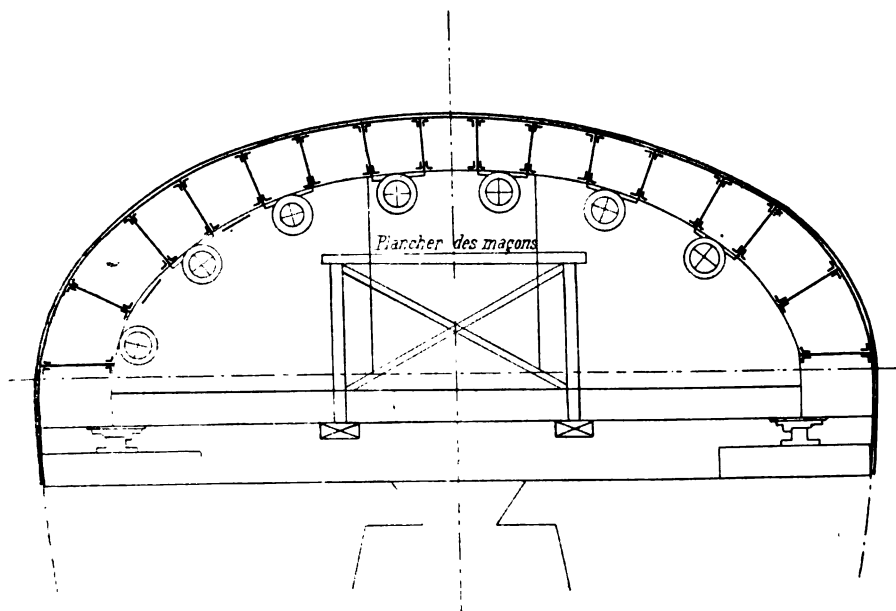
Coupe en travers du bouclier montrant le plancher des maçons,
